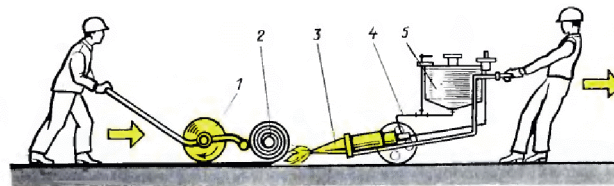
Установка для разогрева покровного слоя наплавляемого рубероида:
